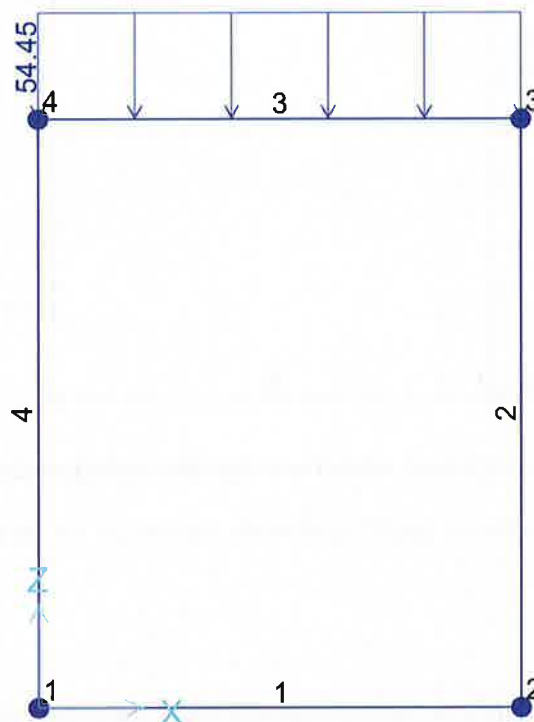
SOVRACCARICO FERROVIARIO (ACCM)
